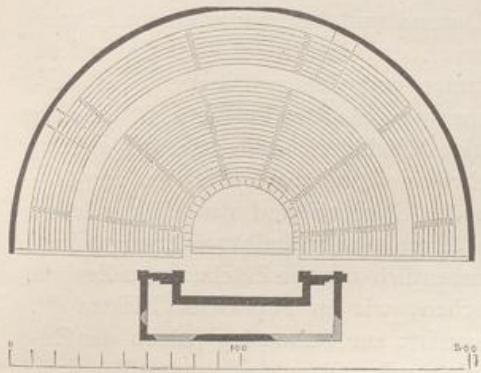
Theater zu Segesta (Grundriss).
